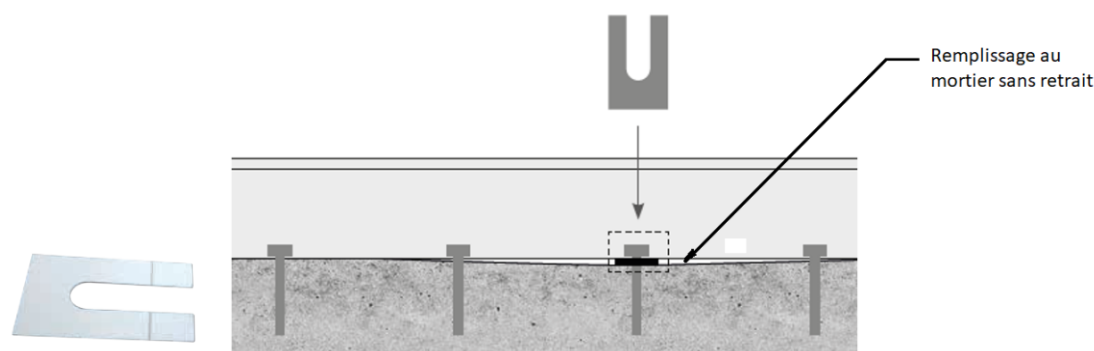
Exemple de cale fourchette de calage sous le profil pour un montage sur du béton
